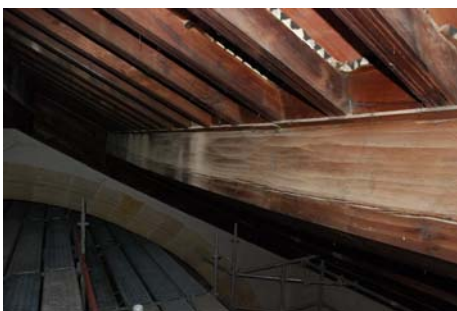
Detalle del apoyo de los pares de cubierta sobre las correas de la Iglesia Parroquial de la Concepción.
